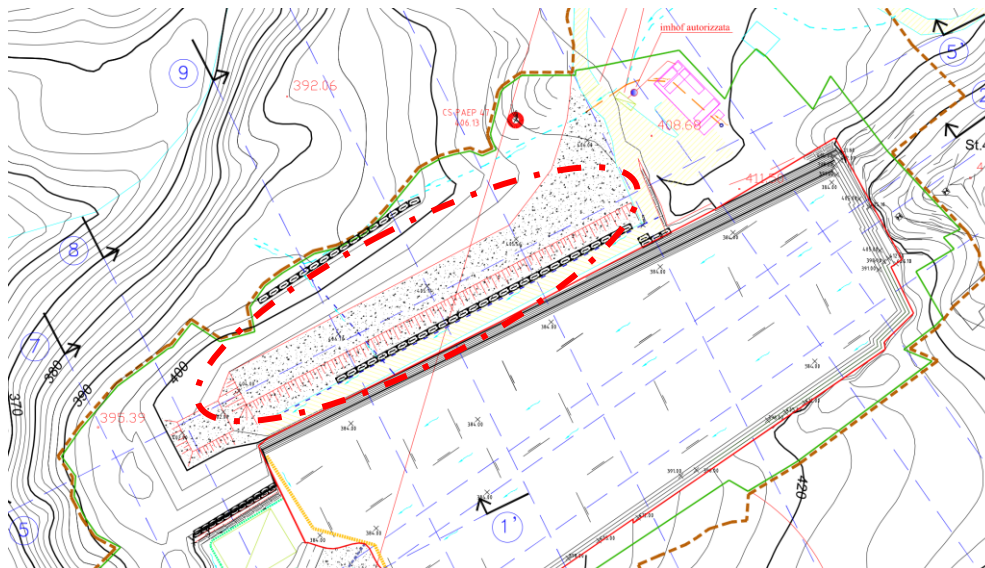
stralcio tavola di progetto - individuazione area fotovoltaico
